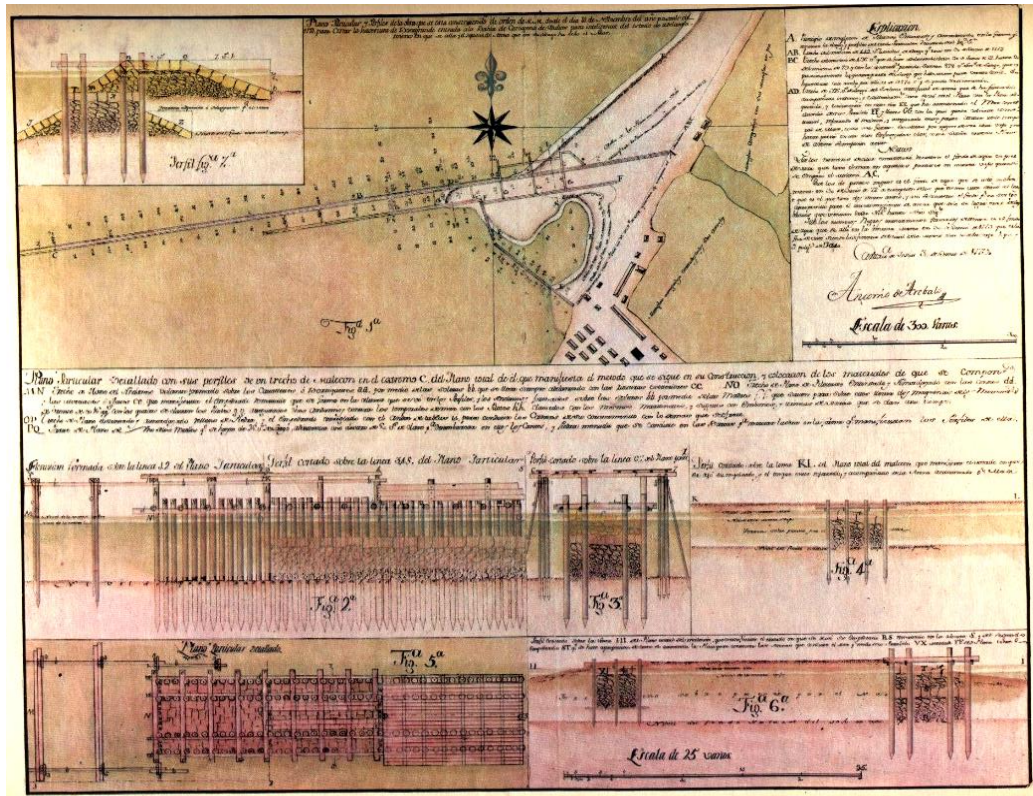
Plano de la construcción de la escollera de Bocagrande en 1773¹⁸²
